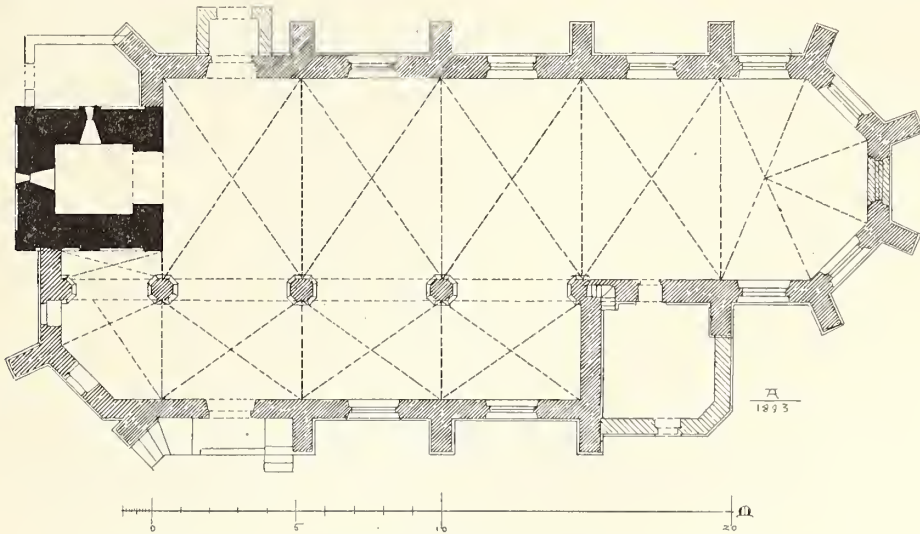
Königshoven. Grundriss der katholischen Pfarrkirche vor der Erweiterung.
